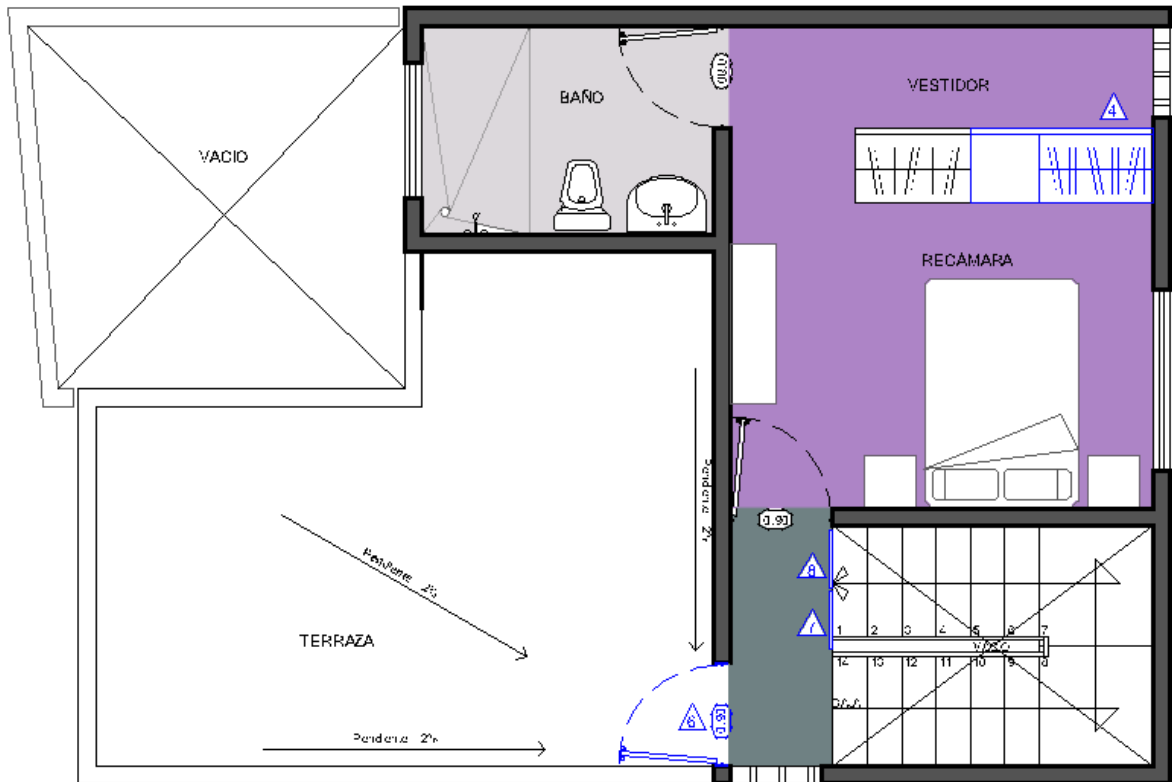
Esquema de Funcionalidad: 3ra. Etapa, Planta Baja
